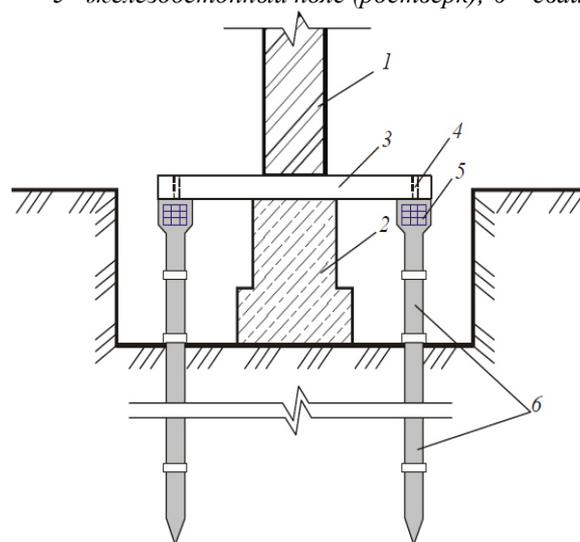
Усиление фундаментов с помощью задавливаемых металлических свай:
